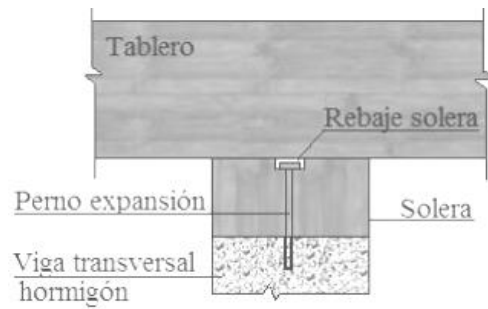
Detalle anclaje solera-viga transversal de hormigón armado [23]
